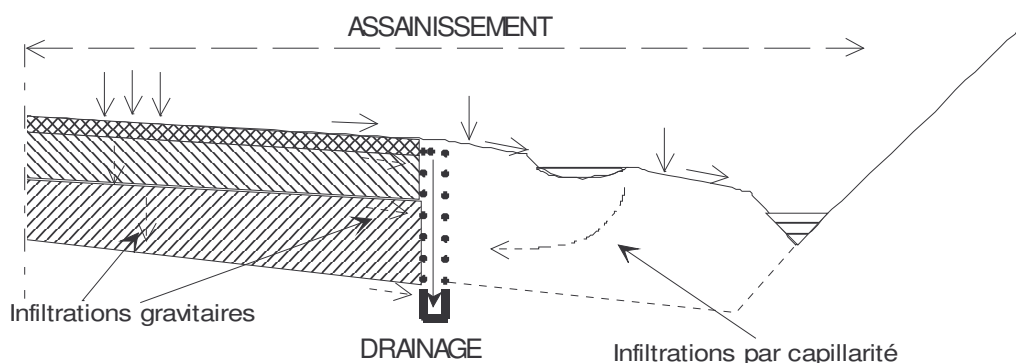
Distinction entre les fonctions de drainage et d'assainissement routier
